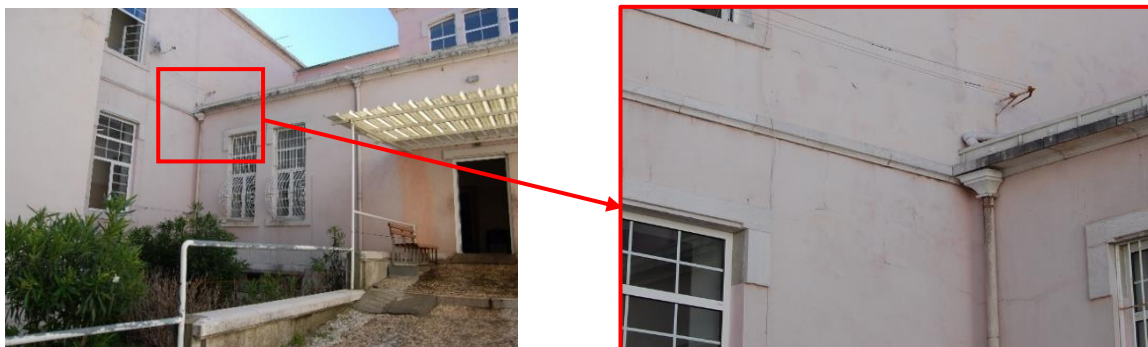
Fissuras no revestimento de pintura [JC, NQ].
